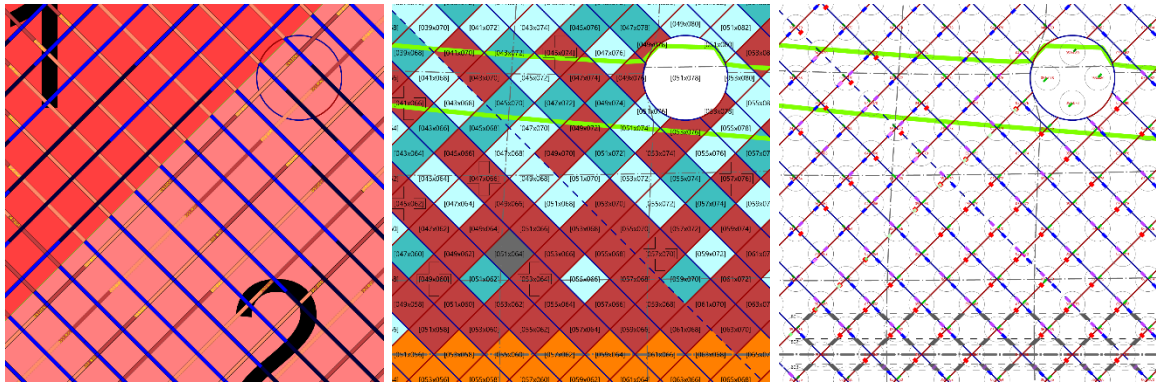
Detaillausschnitte des Flachplans mit (v.l.n.r) Segmentierung und Montagerichtung, Elementtypen, Durchbrüche
